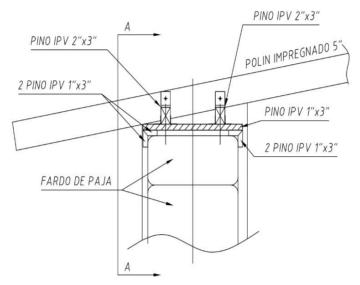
Detalle de la viga de amarre diseñada para el edificio de práctica de yoga. Detalle de unión ente muro y techumbre.
